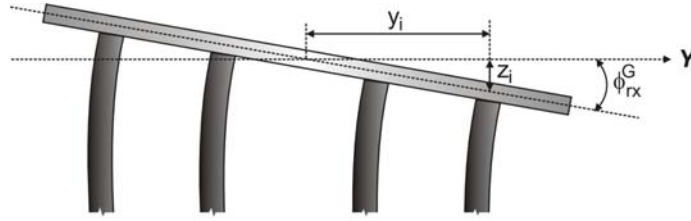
Desplazamiento vertical del *i*-ésimo pilote y el giro global aplicado a la losa.
